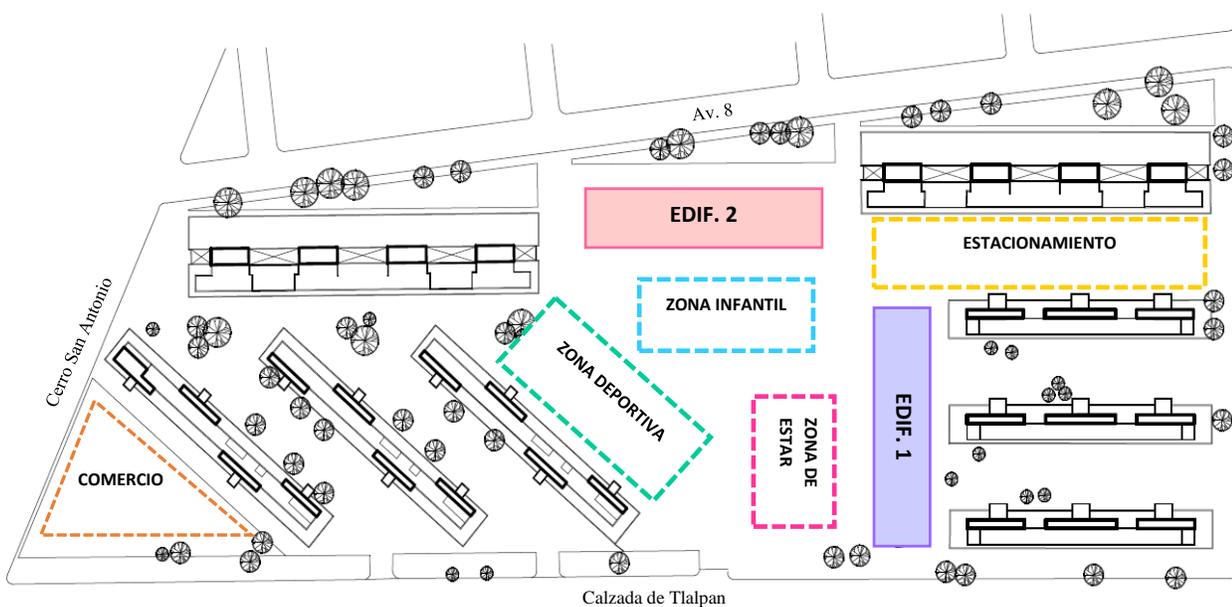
Propuestas de intervención, emplazamiento y distribución de áreas.
